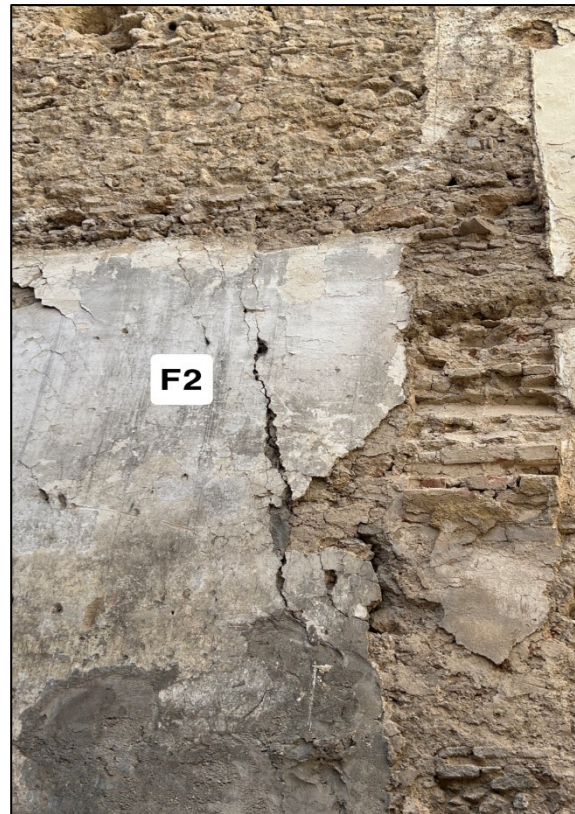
Fissuration verticale sur un mur porteur en maçonnerie
